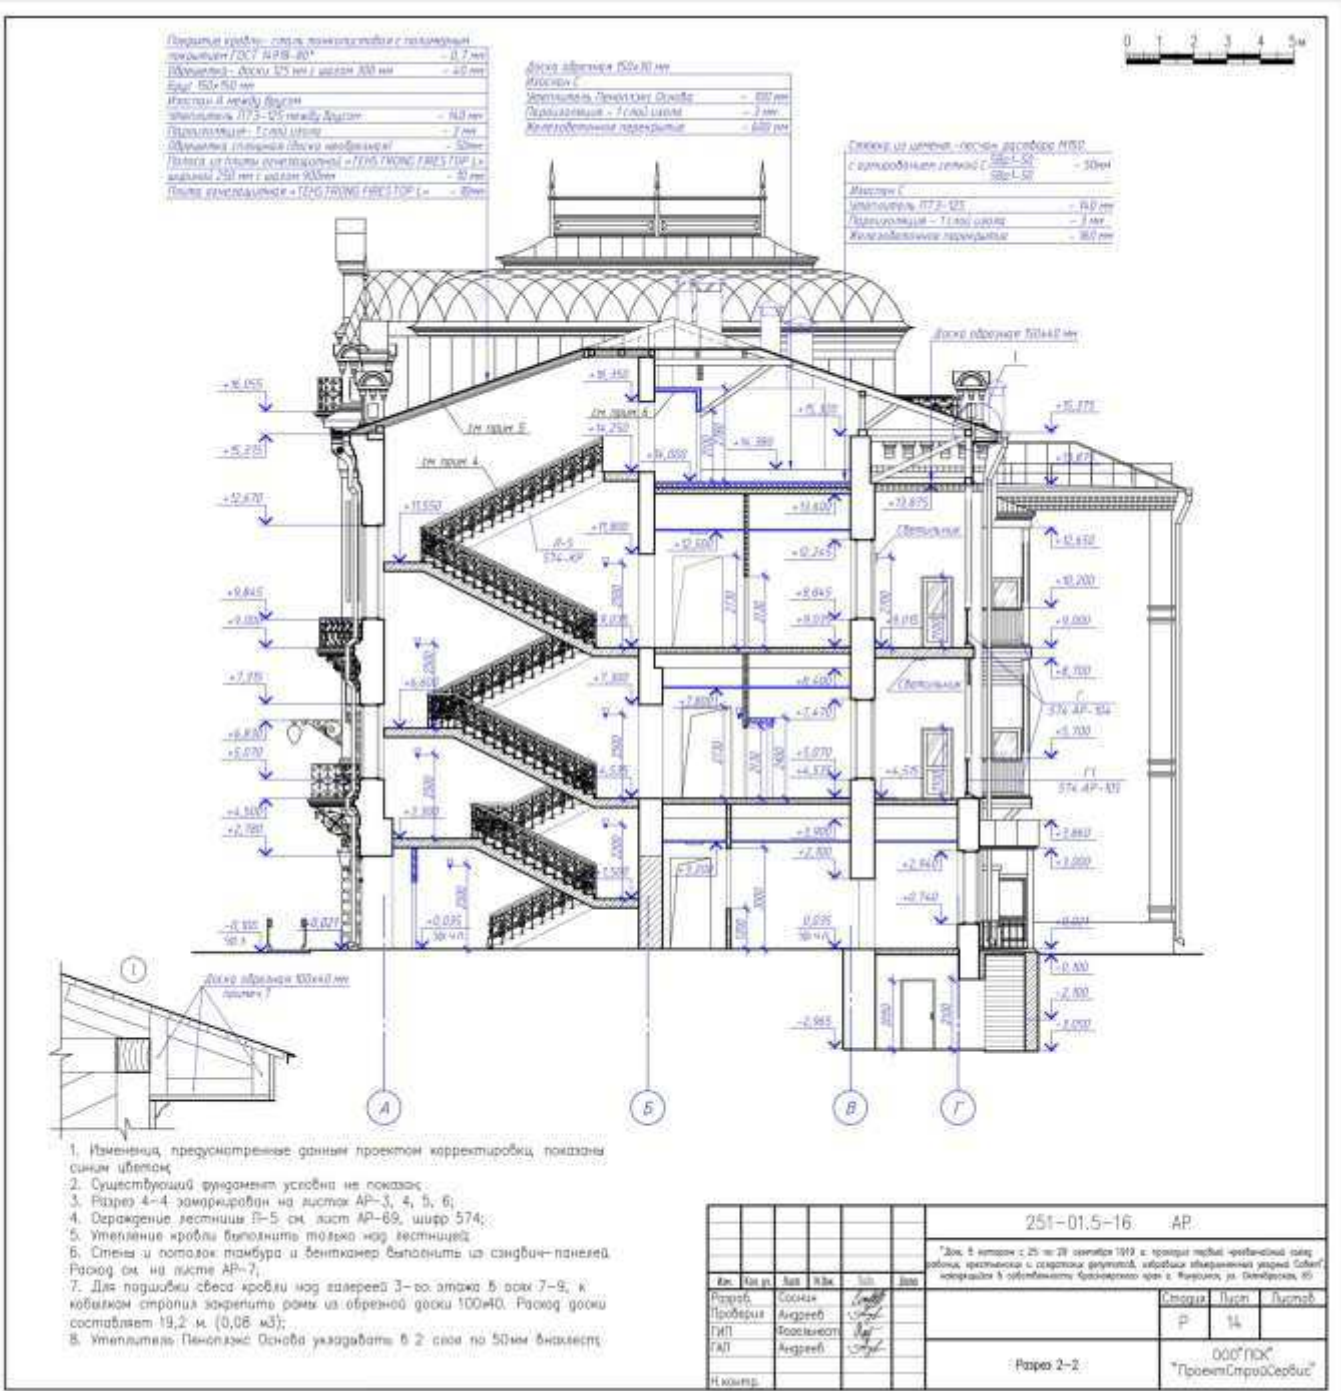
План реконструкции дома Вильнера разрез 3-3
